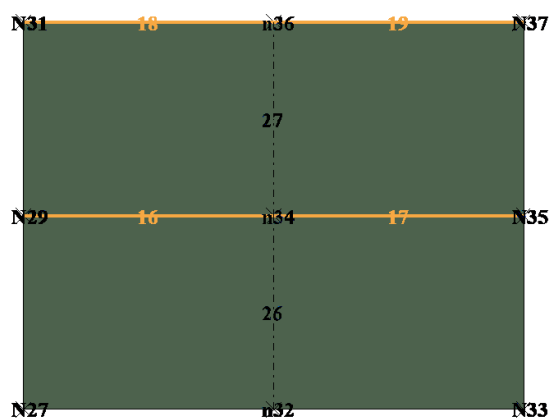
Prospetto Parete 5 - Modello Collegato
